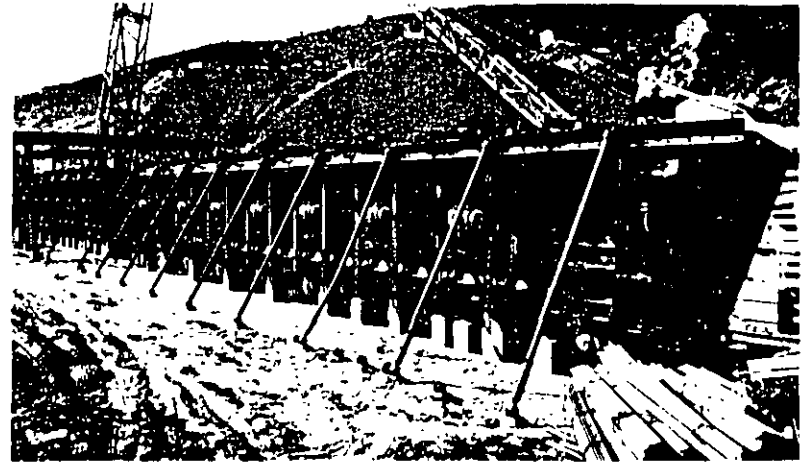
Vibradores adheridos a los lados y al fondo de un encofrado de prefabricación.
